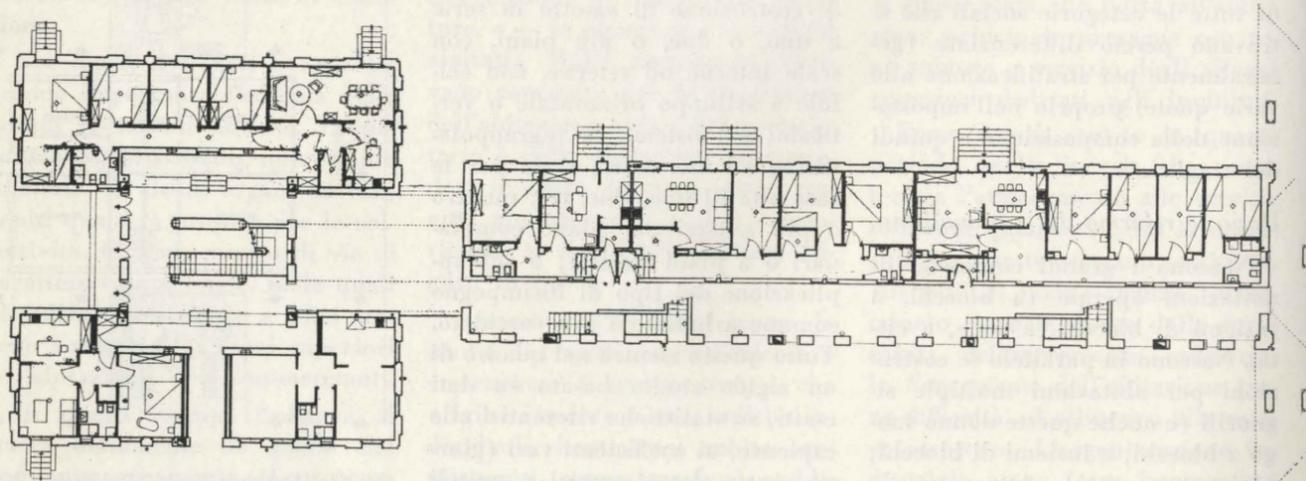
Zona G alle Vallette di Torino. Pianta del tipo edilizio.
